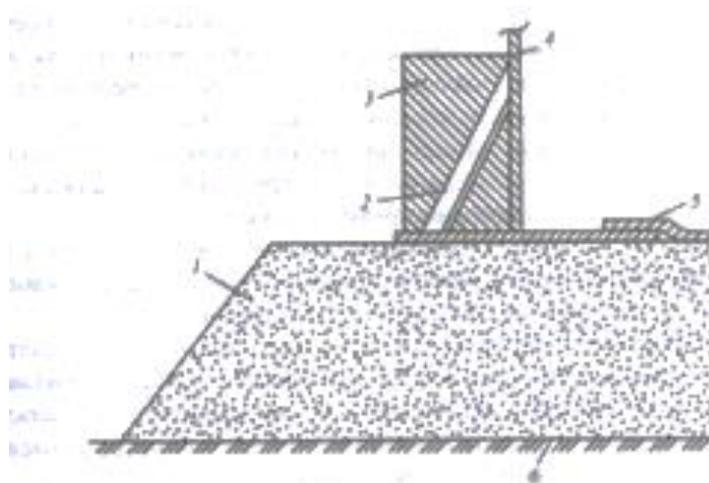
Усиление узла примыкания стенки к днищу:
